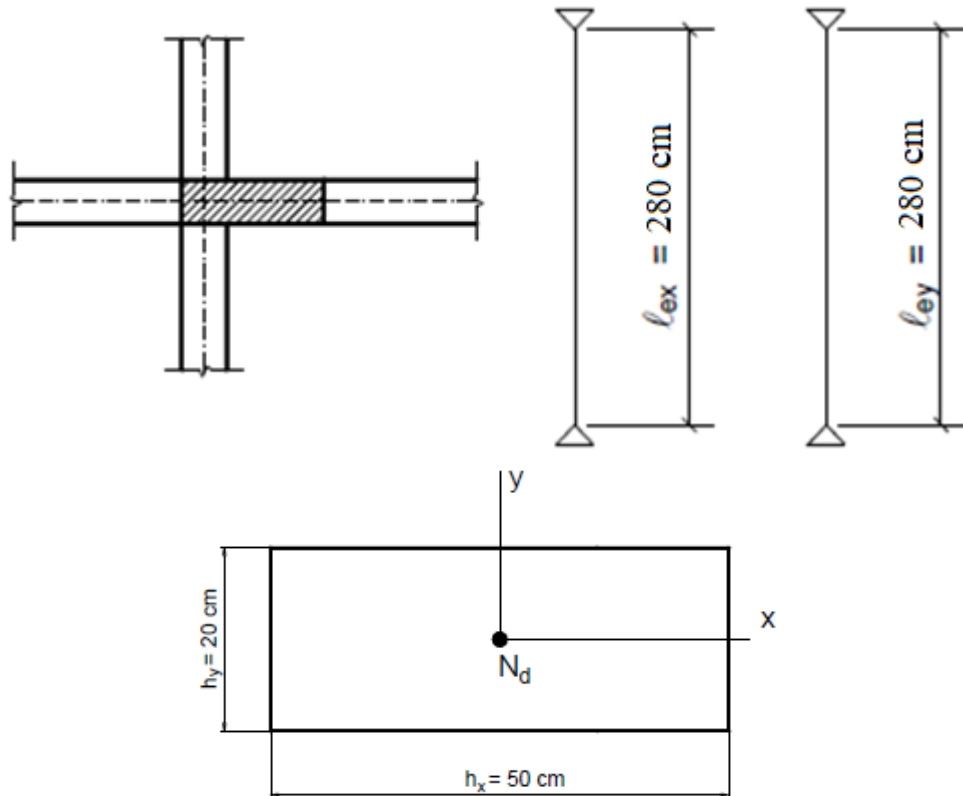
Posição do pilar em relação às vigas, vínculos na base e no topo nas direções x e y, dimensões da seção transversal e situação de projeto
